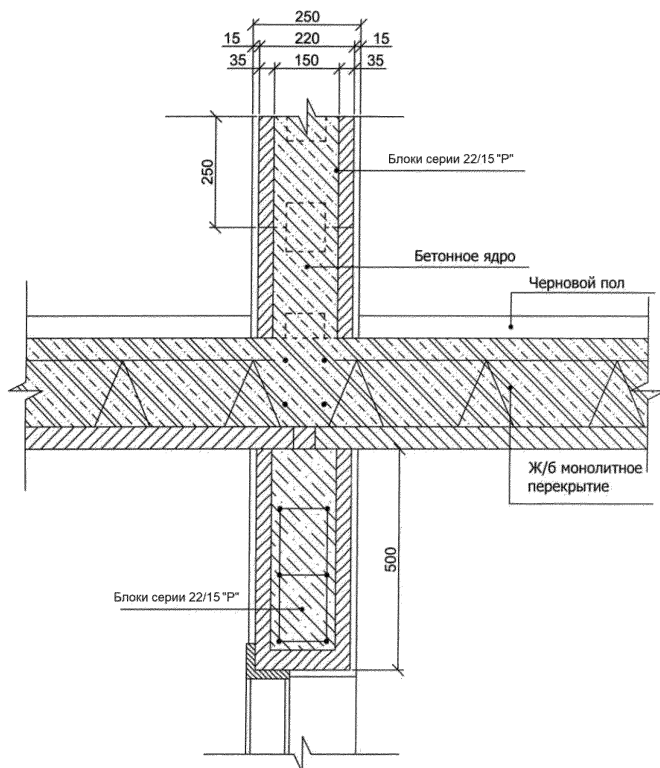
Внутренняя несущая стена, монолитное перекрытие и перемычка на дверным проемом с применением блоков серии 22/15 «Р»
